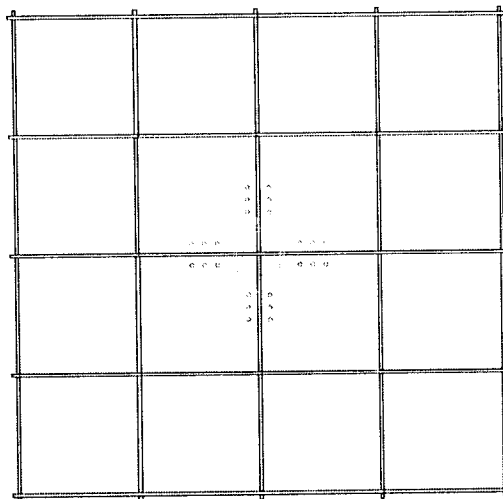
Distribuição da Armadura Longitudinal Comprimida do Modelo.
